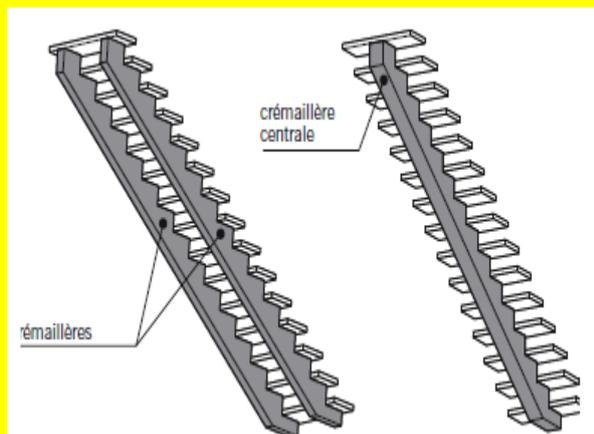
Escaliers préfabriqués avec crémaillères en béton
